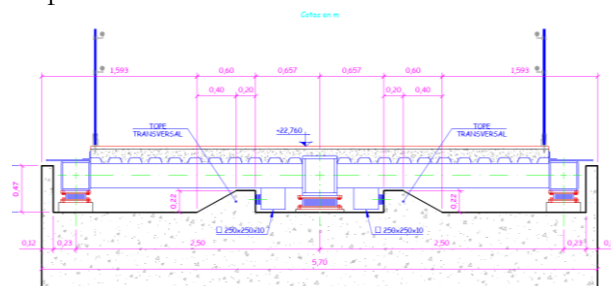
Apoyo y fijación horizontal de pasarela a pila intermedia.
